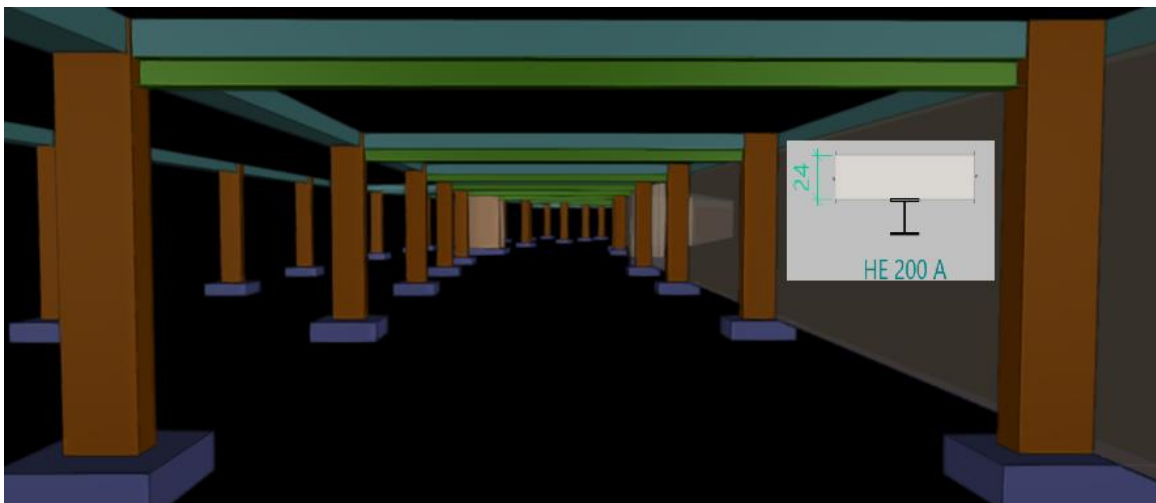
Vista 3D dos reforços introduzidos na laje do piso -2
